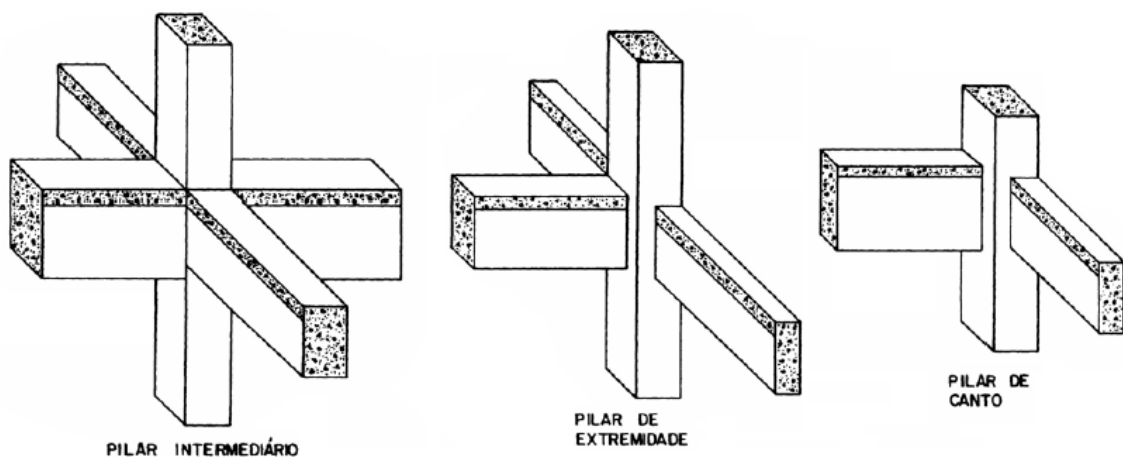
detalhes de pilares usuais de edifícios de concreto armado
